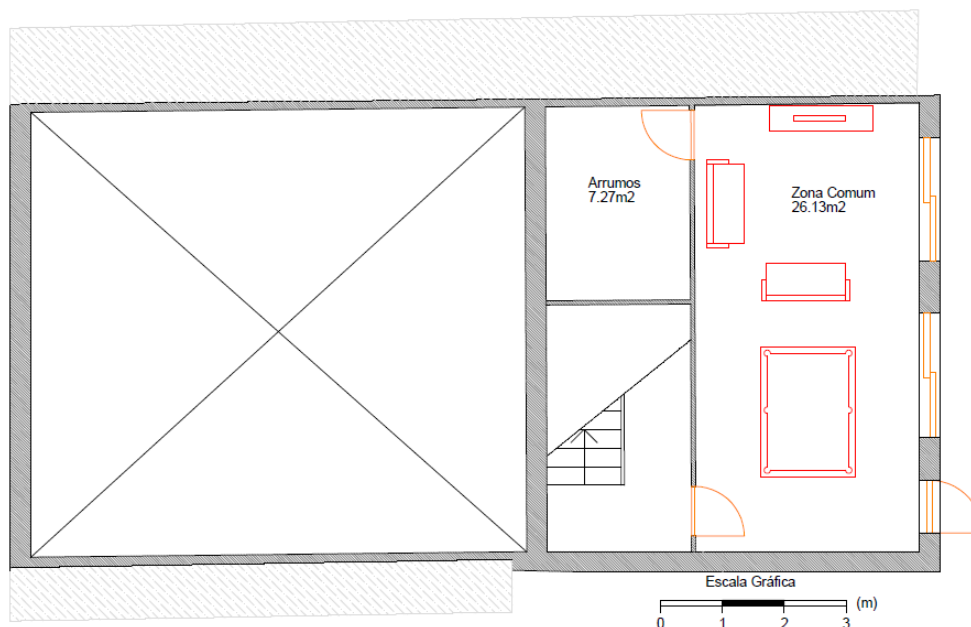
Planta do Piso -1 do Edifício Reabilitado
